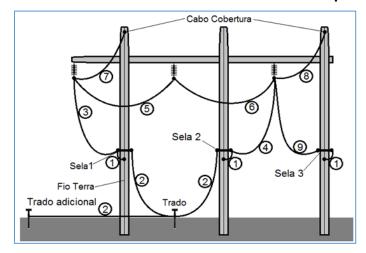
Conjunto para estrutura de madeira e concreto circular ou duplo T
